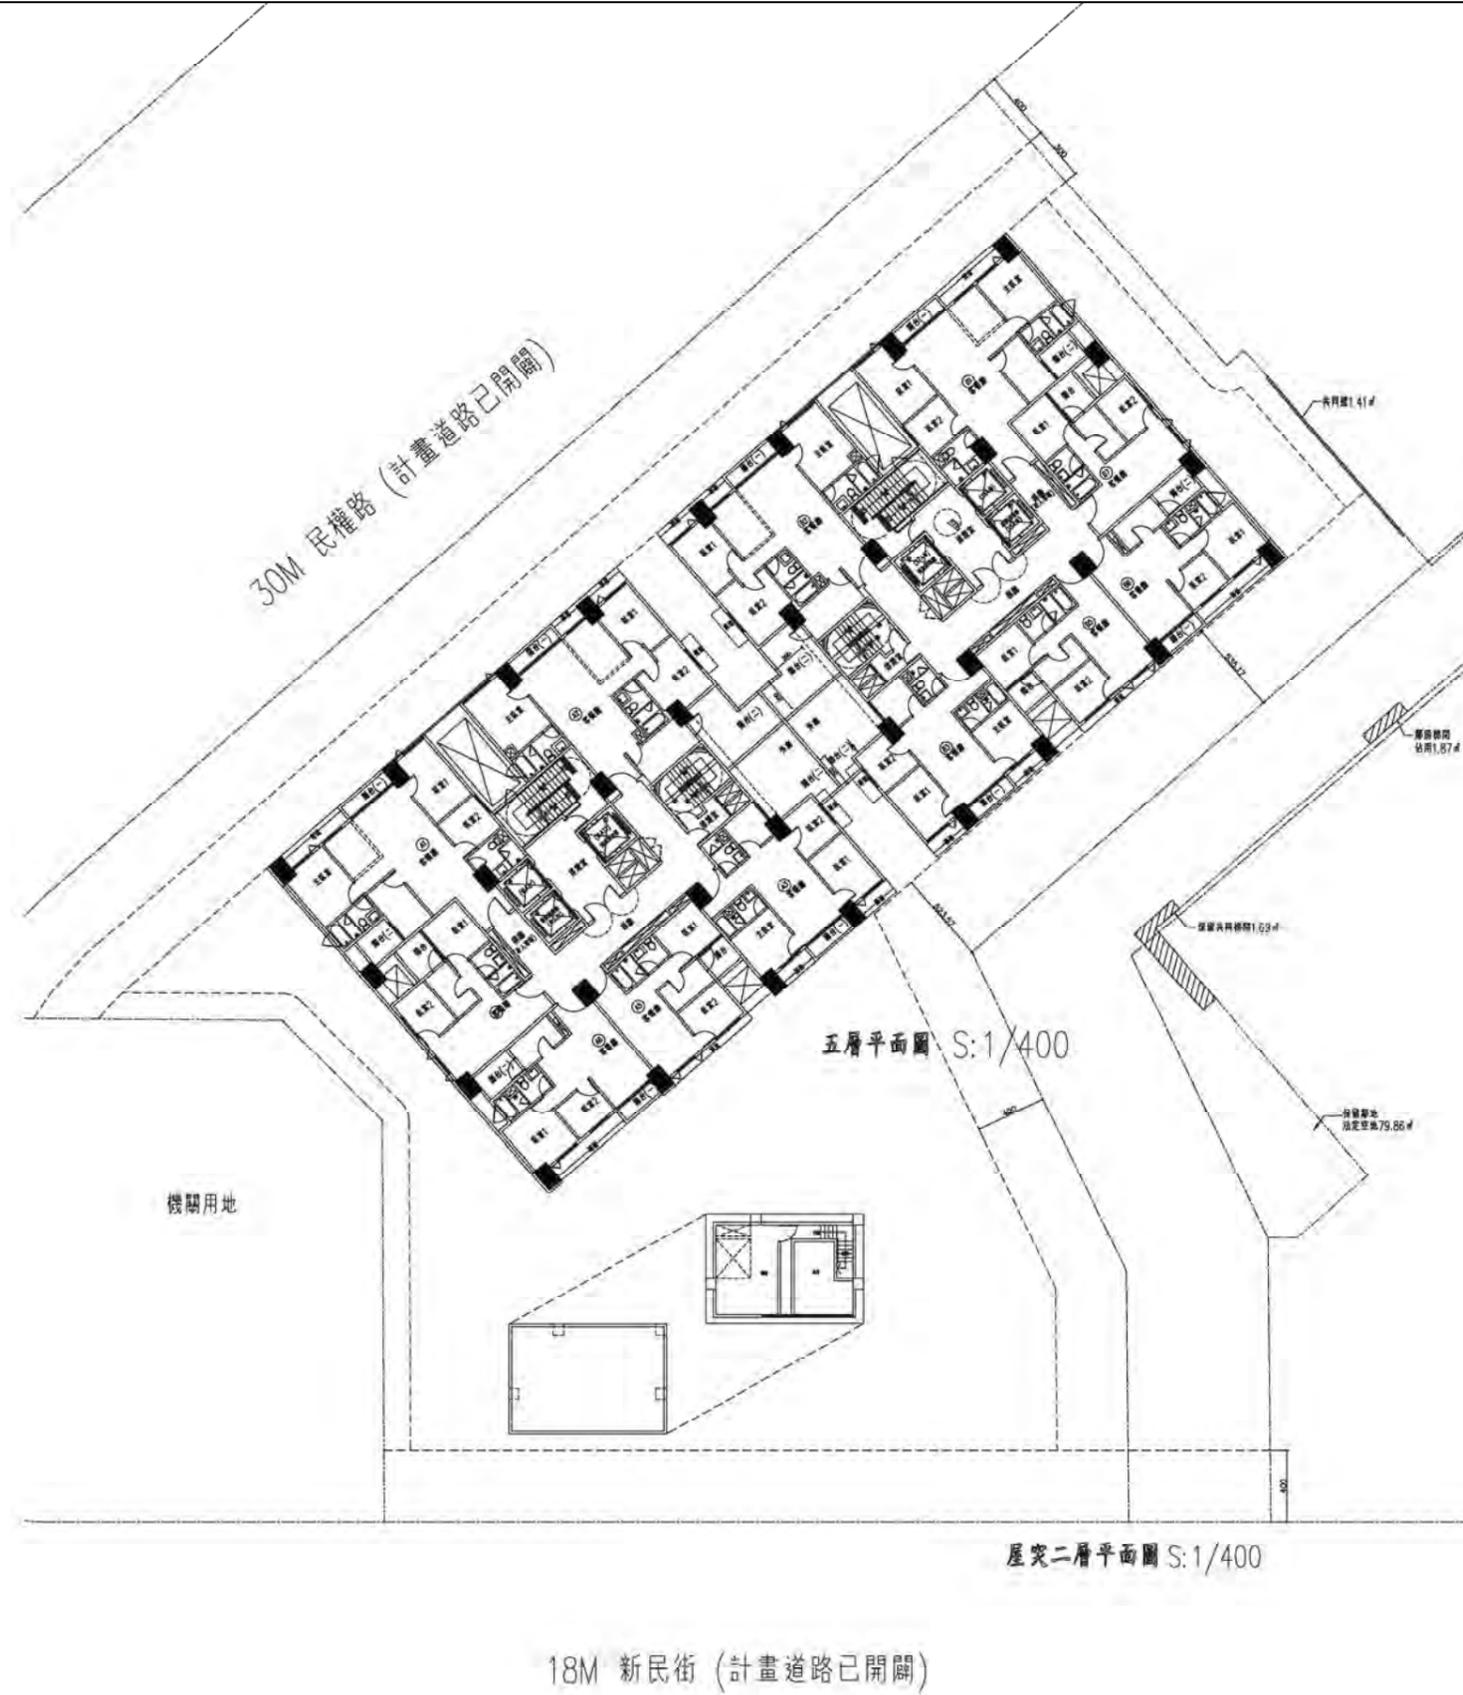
A、B 棟五層及 C 棟屋突二層平面圖
